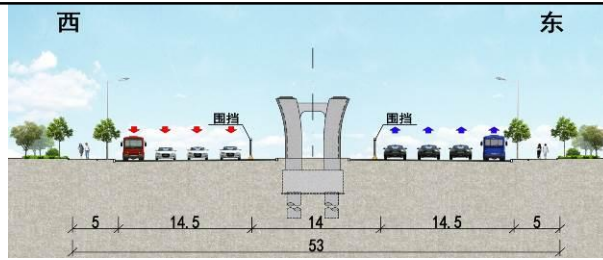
重庆路双向十车道段主线桥梁下部结构施工调流断面图
